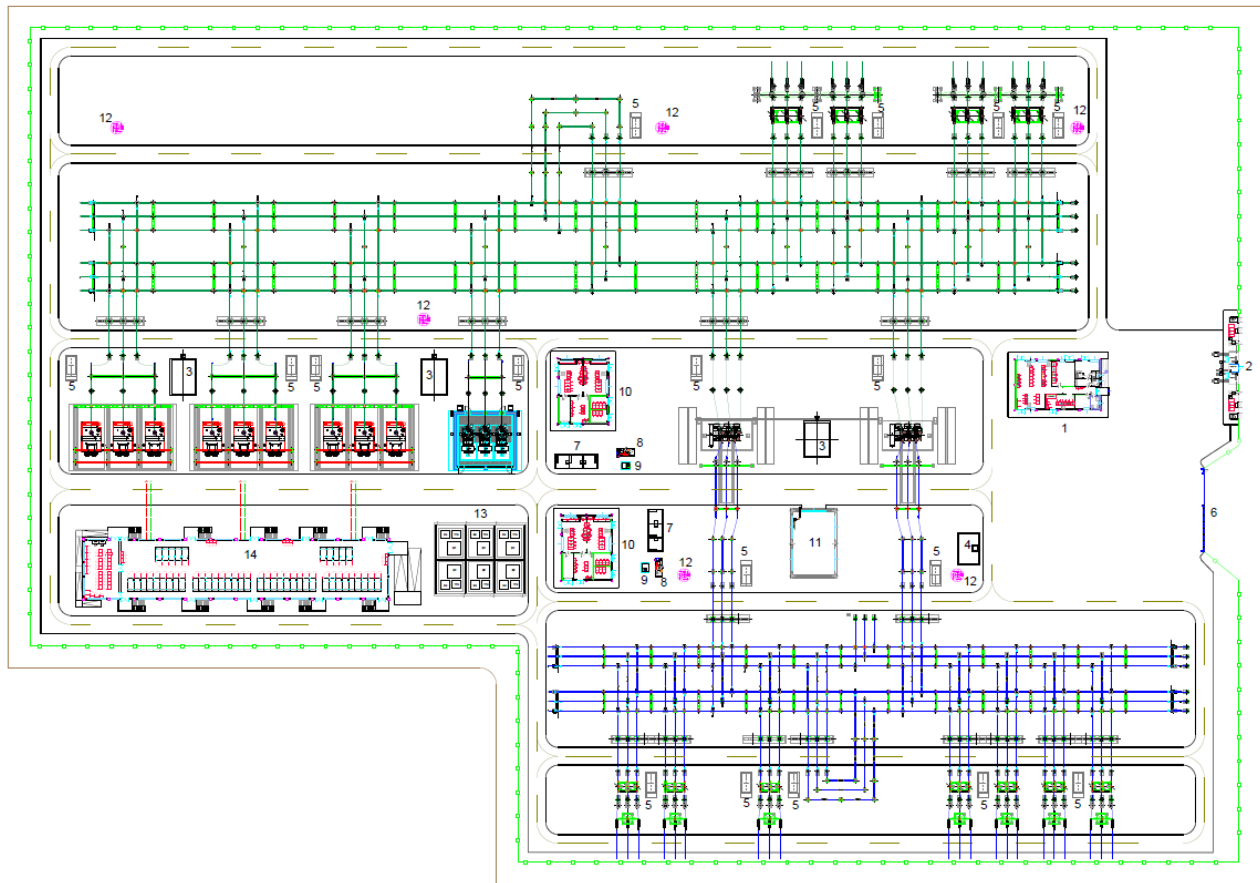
Planimetria preliminare studio prefattibilità nuova SE Terna
